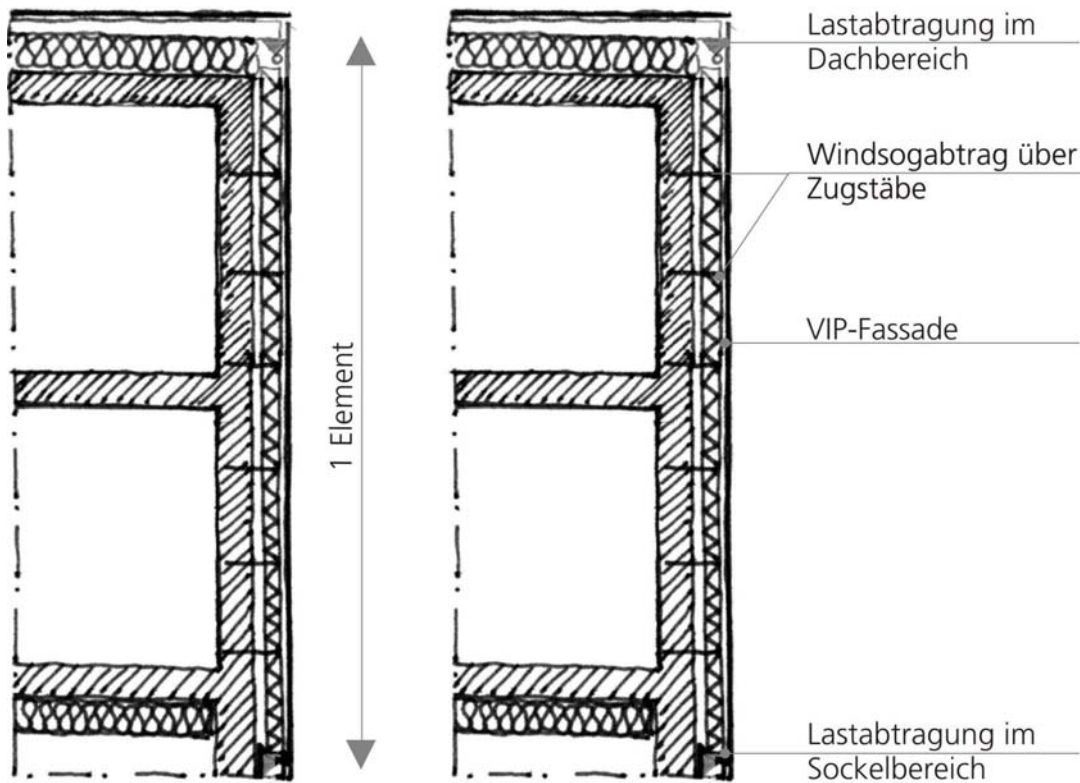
Aufbau einer „hängenden“ Fassade (PDrei)
